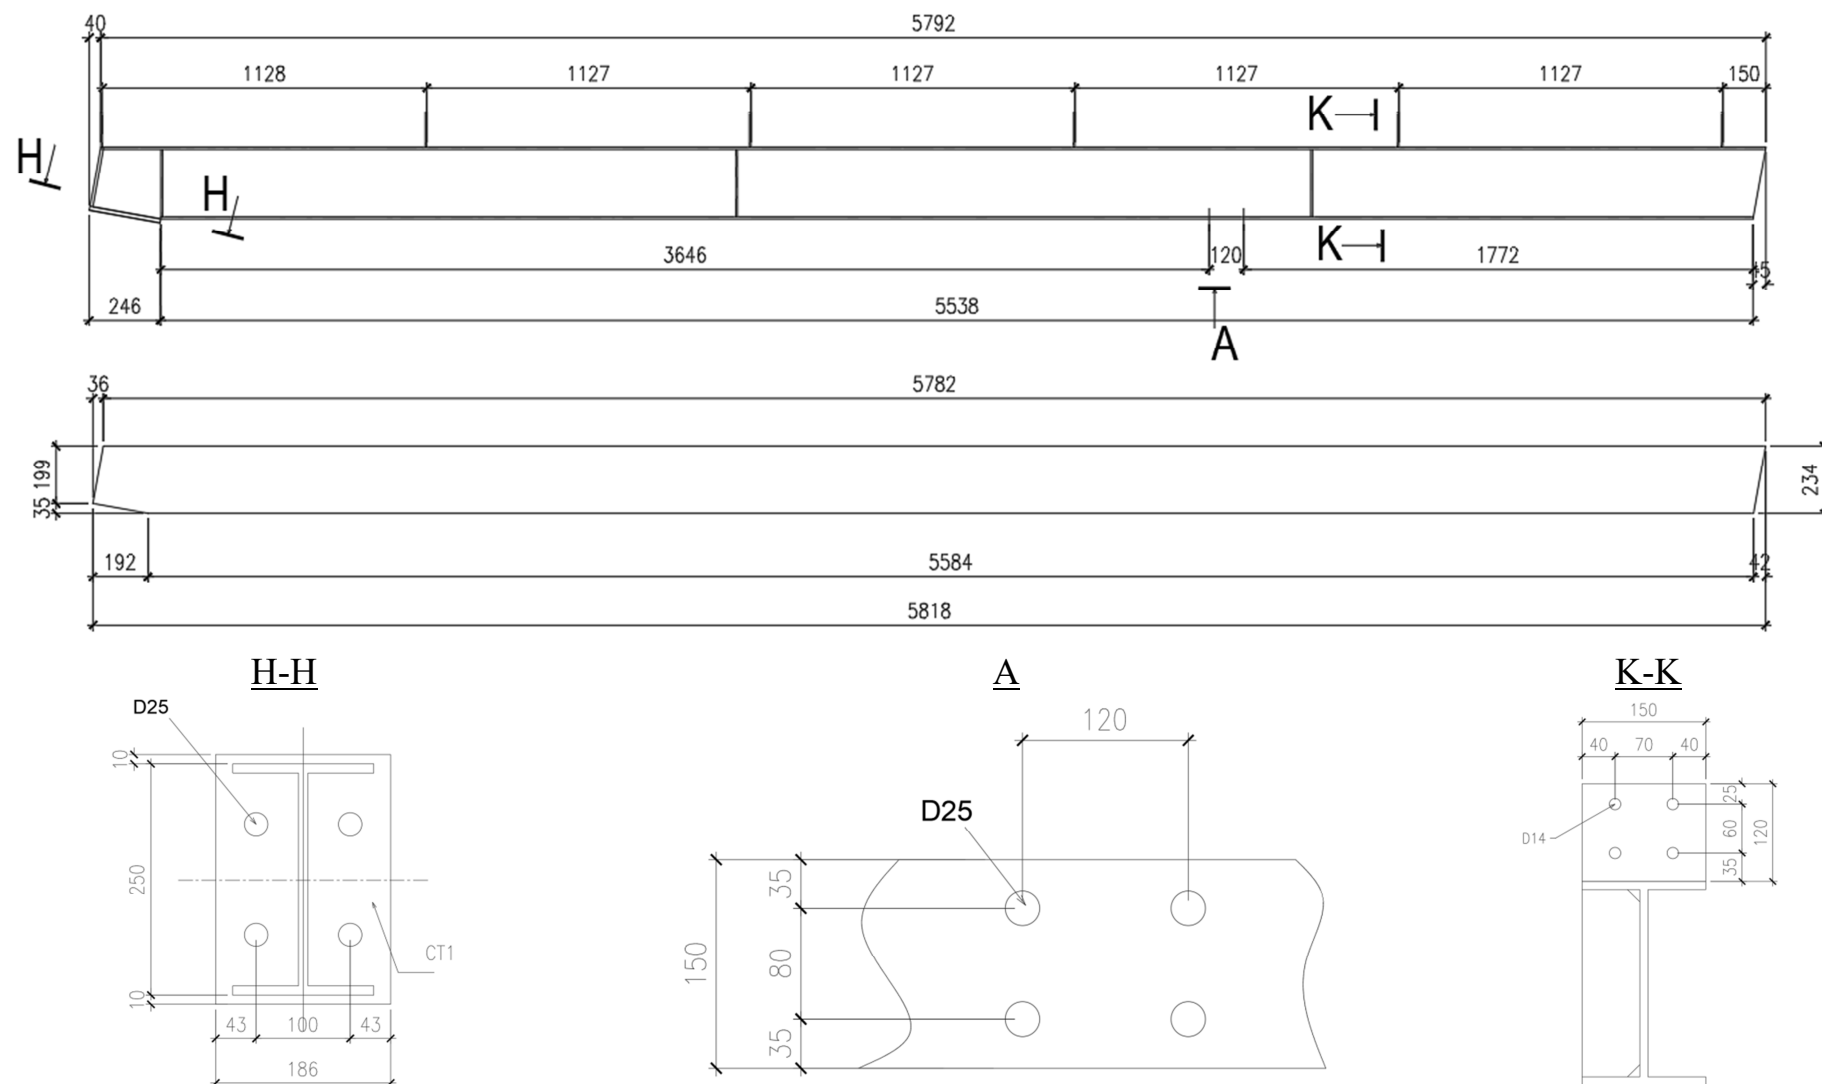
Балка (H250×186×8×8), разрезы Н-Н, К-К и деталь А
